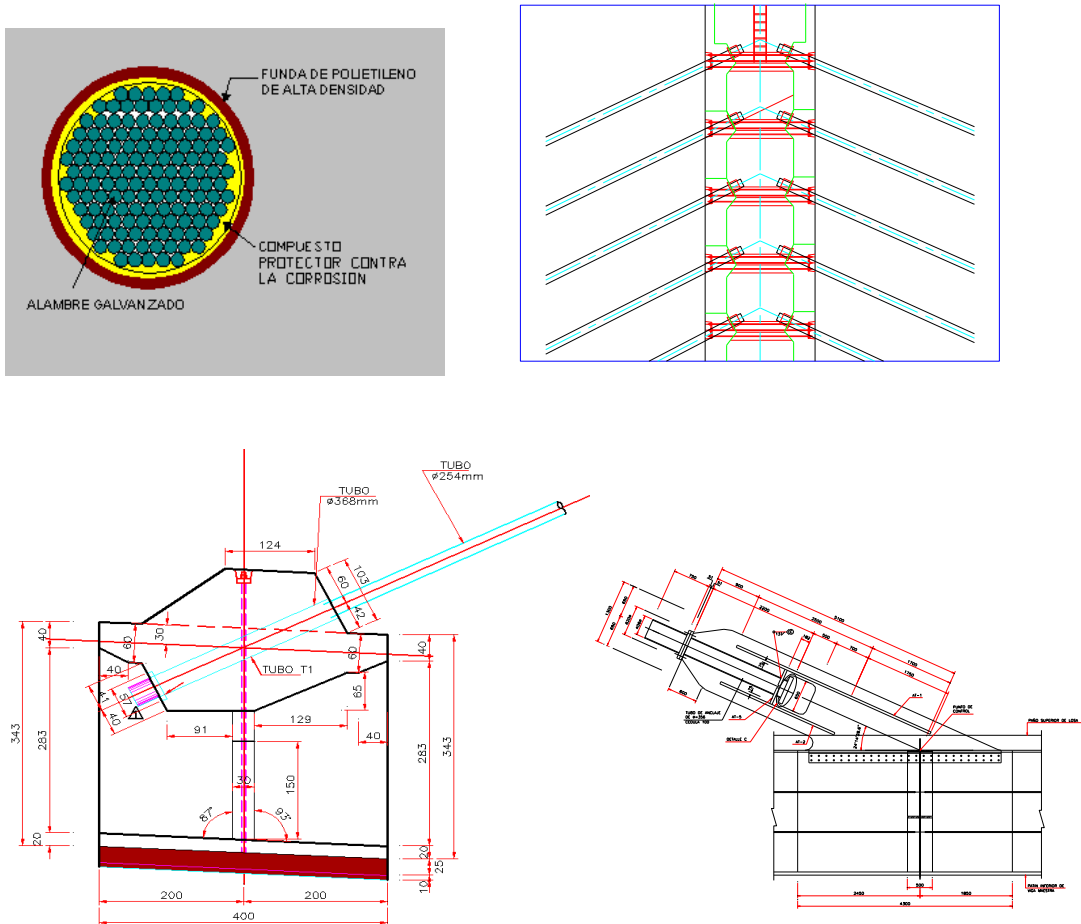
Detalles del atirantamiento y anclaje del puente Baluarte
